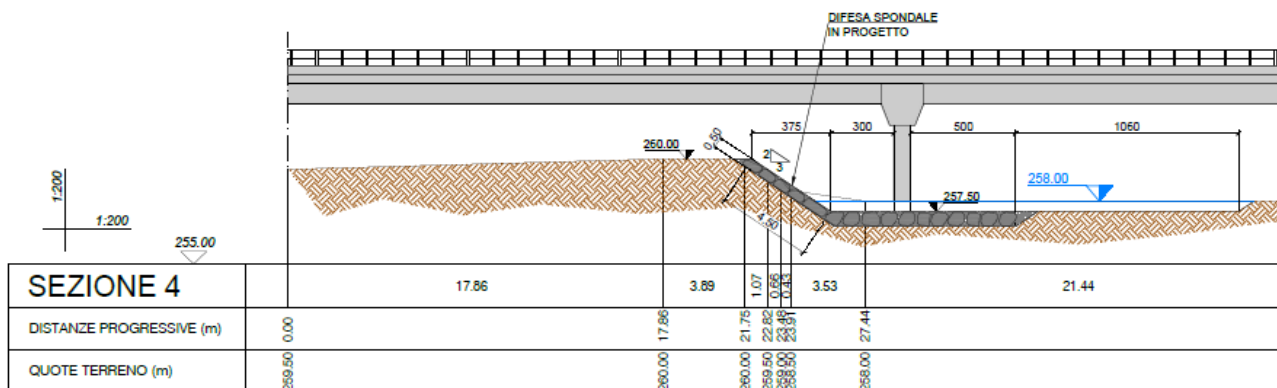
Sezione 4 sponda sinistra alveo – Intervento 1 (Stato di progetto)
